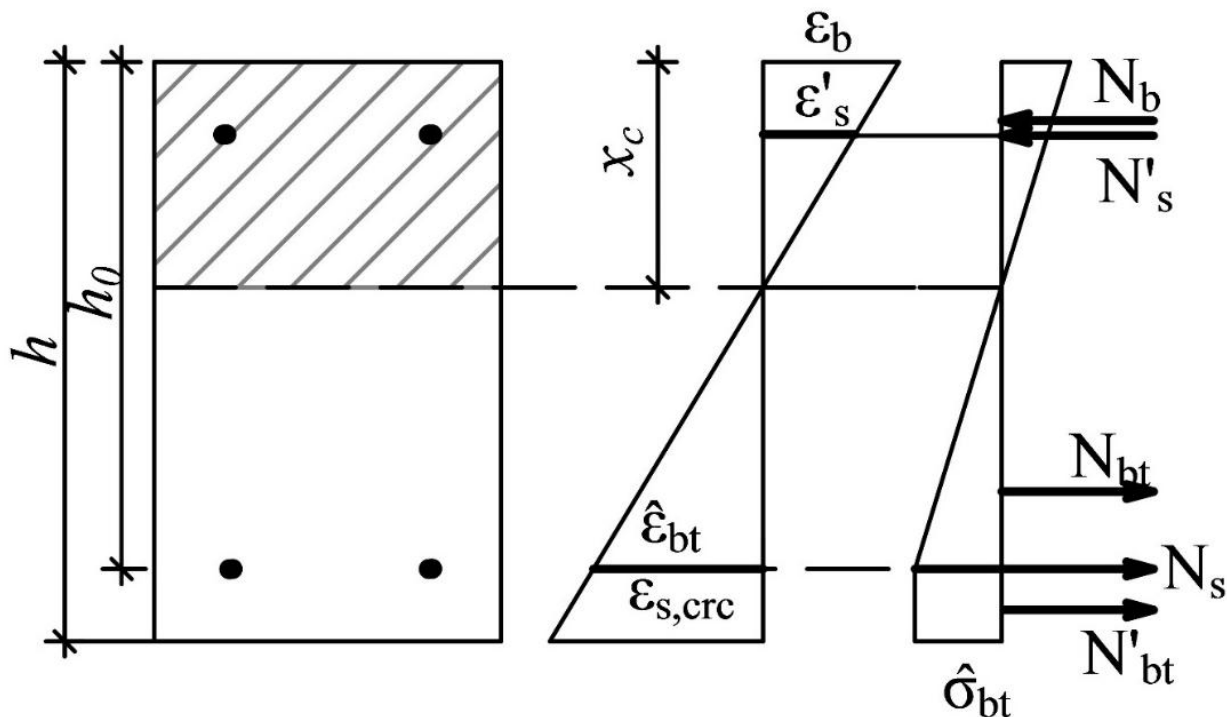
К расчету момента трещинообразования стержневых железобетонных элементов по деформационному методу
